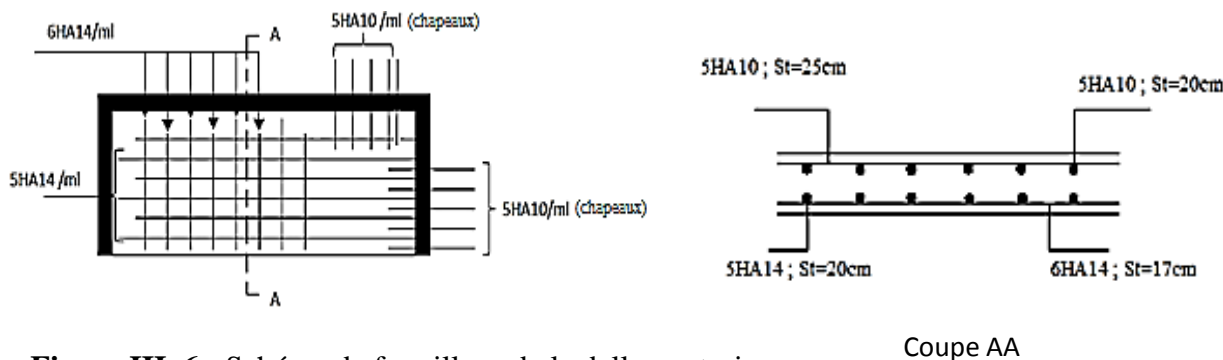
Schéma de ferrailage de la dalle sur trois
